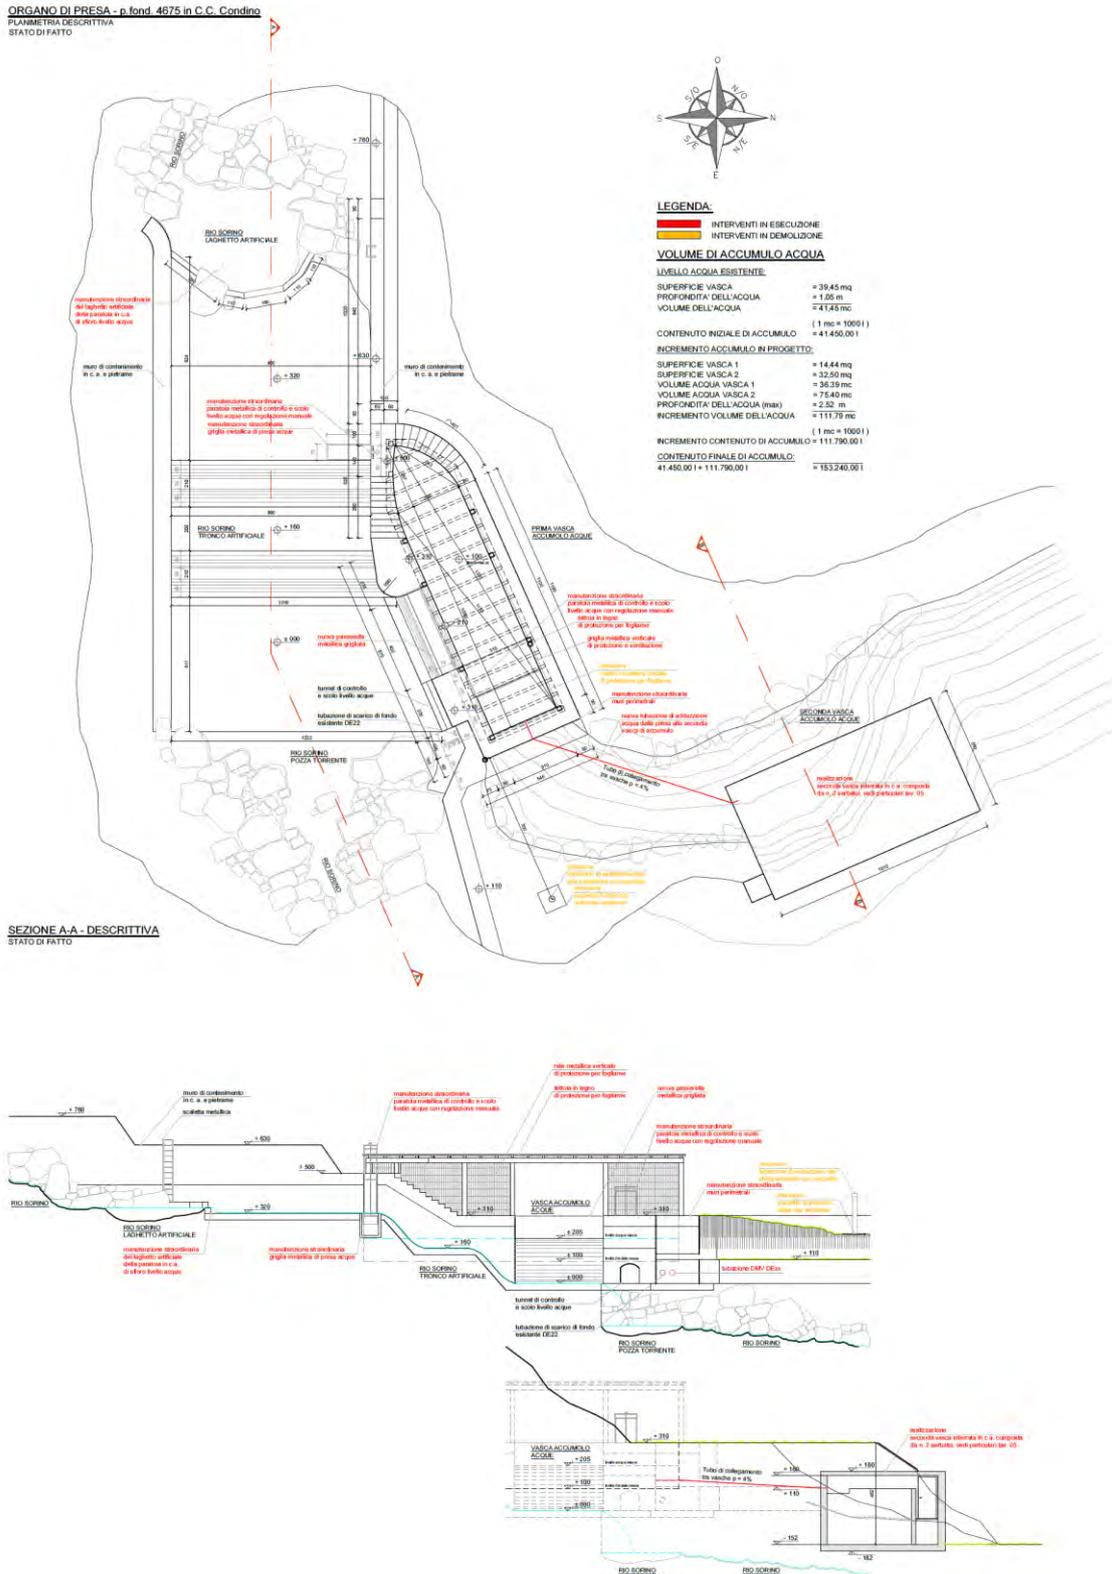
Planimetria e sezione dello stato di fatto dell'opera di presa
